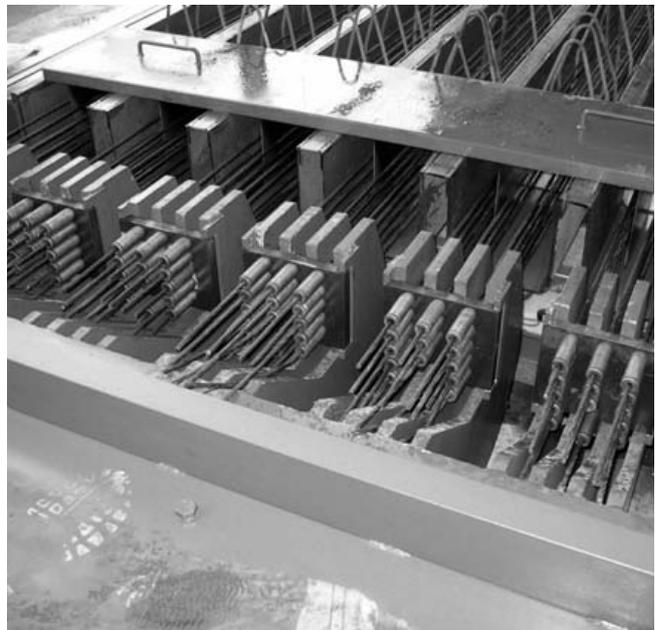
Tipología de refuerzo usado para el pretensado. Torón de acero trefilado.
